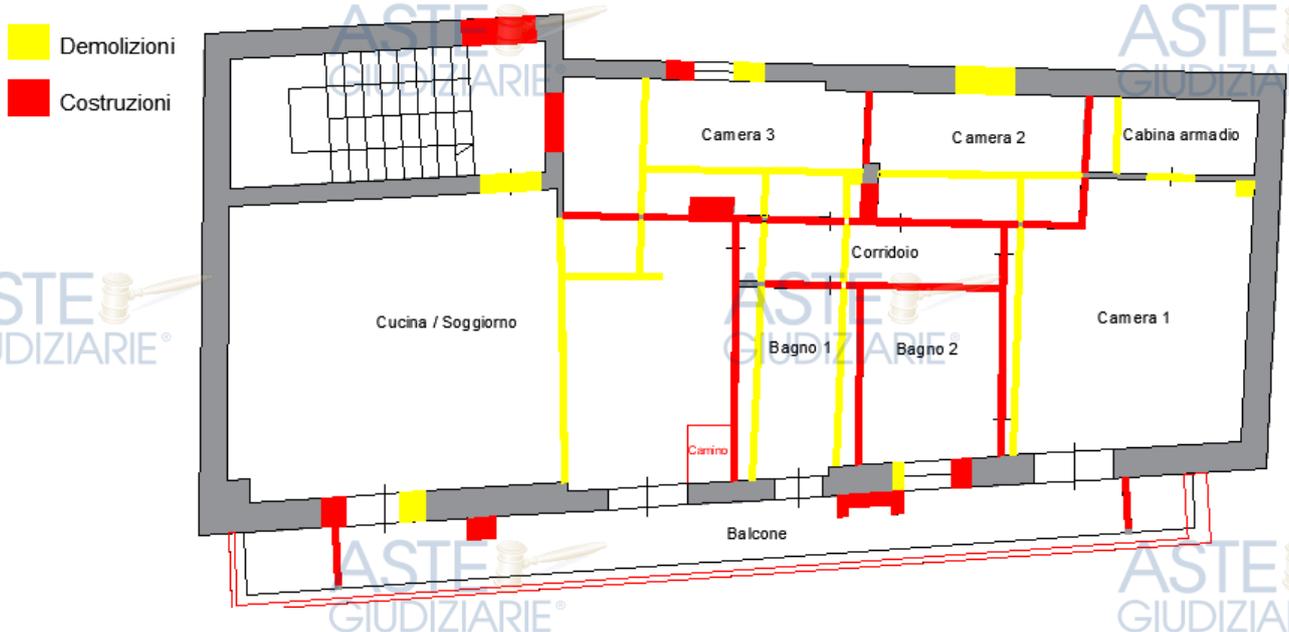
Confronto catastale - pianta piano secondo del sub.12
